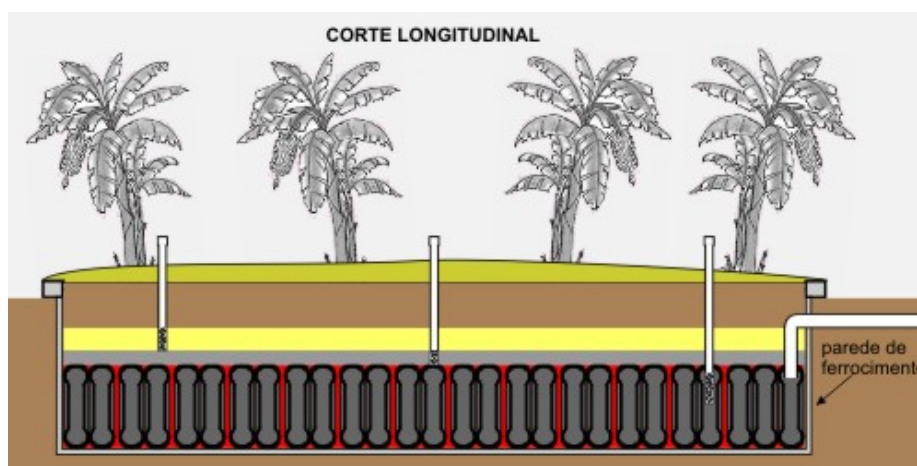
Esquema de Construção do Tanque de Evapotranspiração (Corte Longitudinal)
